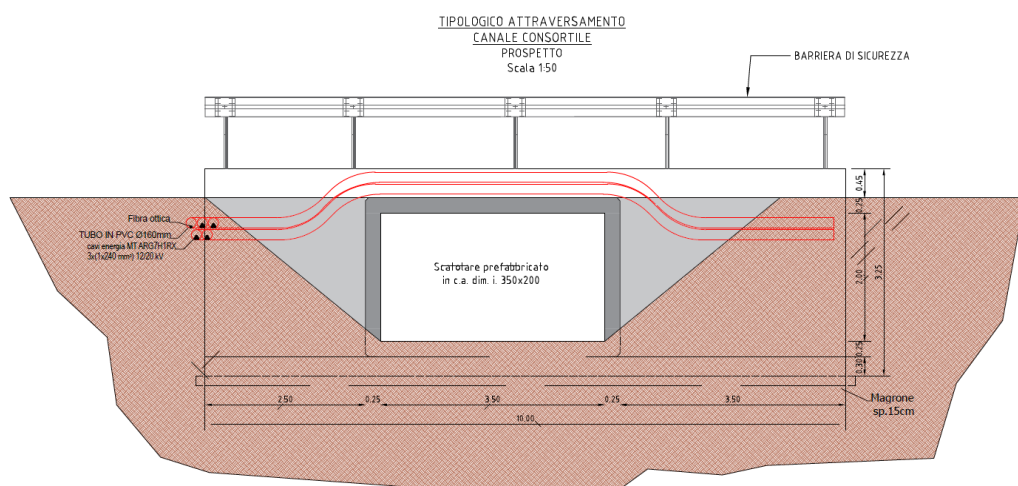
Prospetto tipologico attraversamento canale consortile con cavidotto di connessione
